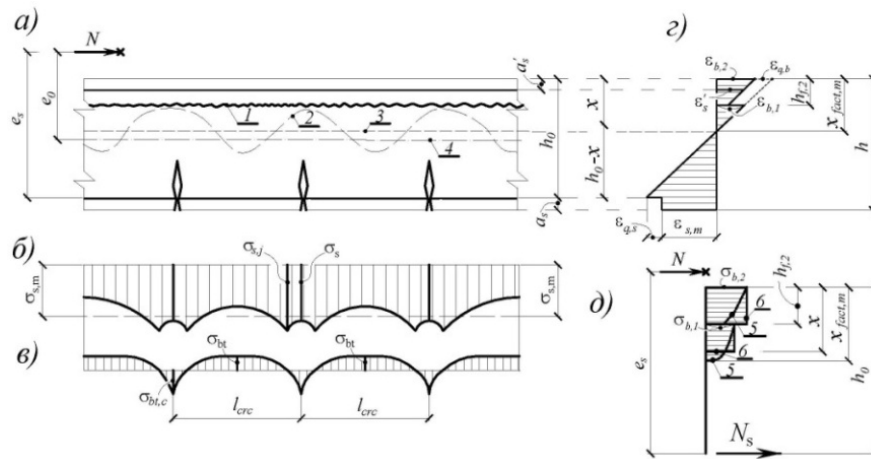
Типичные картины деформирования бетона и арматуры в железобетонном внецентренно сжатом элементе с трещинами при учете эффекта, связанного с нарушением сплошности бетона и условного сосредоточенного сдвига между бетонами и между арматурой и бетоном: а – схема образования трещин; б, в – эпюры напряжений в растянутой арматуре и растянутом бетоне; г – гипотеза средних деформаций в поперечном сечении составного железобетонного элемента; д – внутренние усилия в сечении с трещиной; 1 – шов между бетонами; 2, 3 и 4 – физическая, средняя и геометрическая нейтральные оси, соответственно; 5 – действительные эпюры напряжений сжатия в первом и втором бетоне составного стержня; б – то же, принятые для расчета
